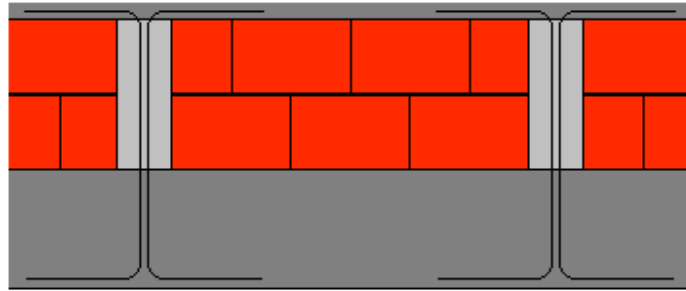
Coupe transversale des fondations avec les ferrailles des poteaux.
